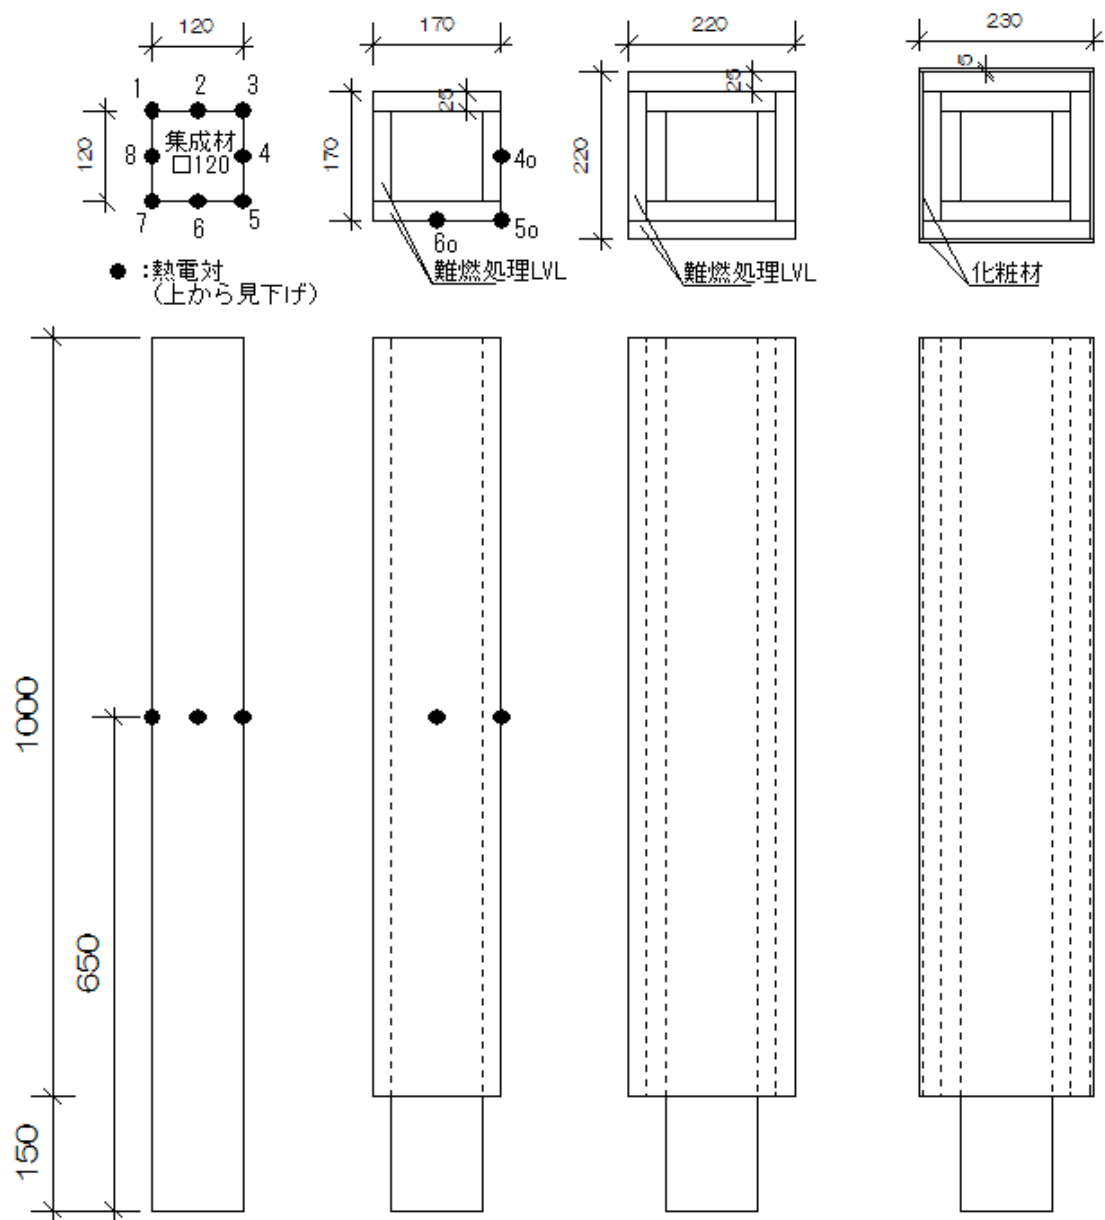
試験体平面図および断面図、熱電対位置
